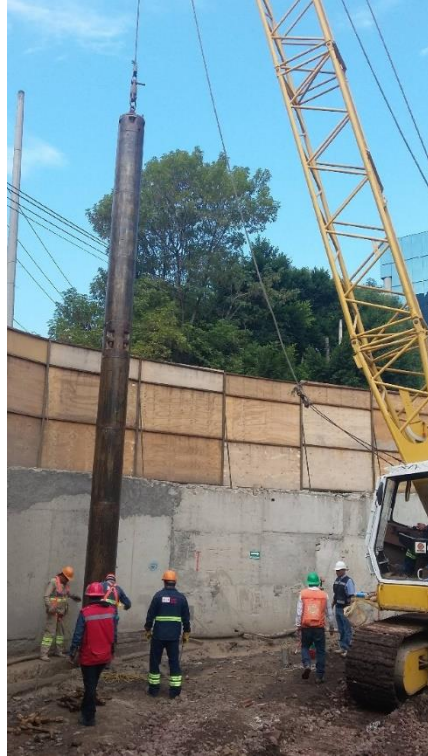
Junta metálica de sección circular para machihembrado de paneles.
